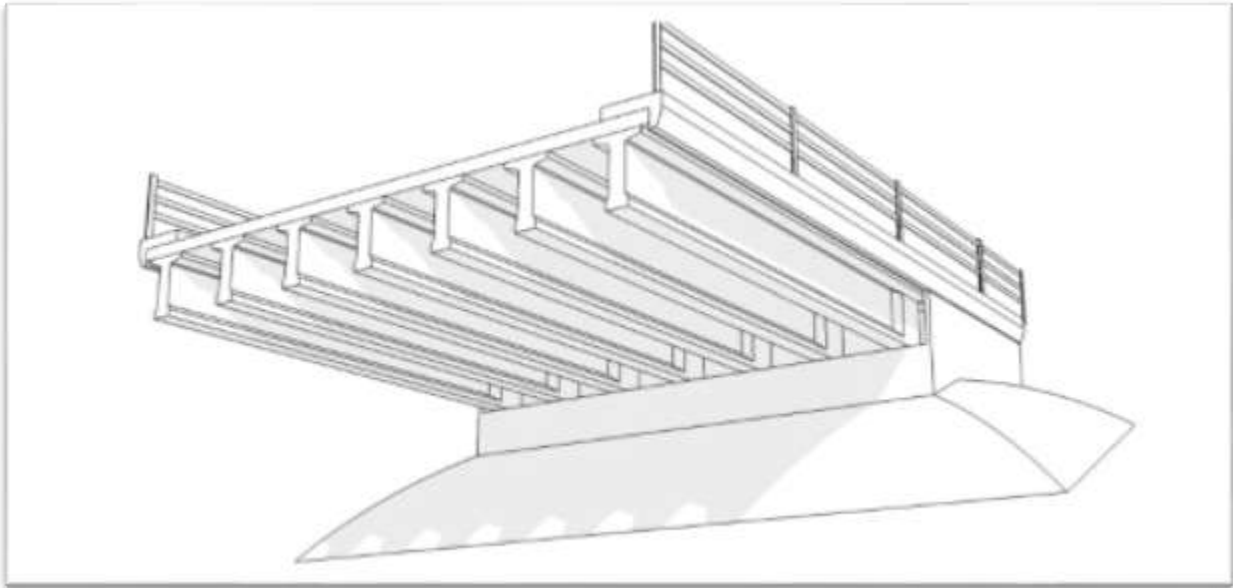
composition générale d'un pont à poutres en béton précontraint
